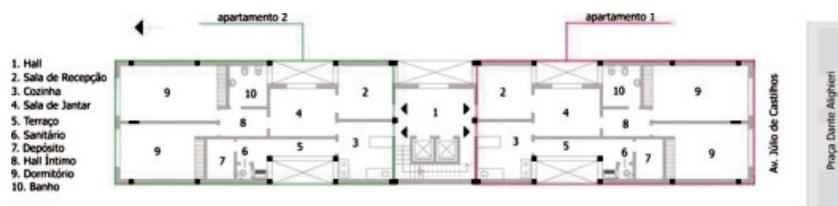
Planta baixa dos fluxos do Ed. Ettore Lazzarotto
